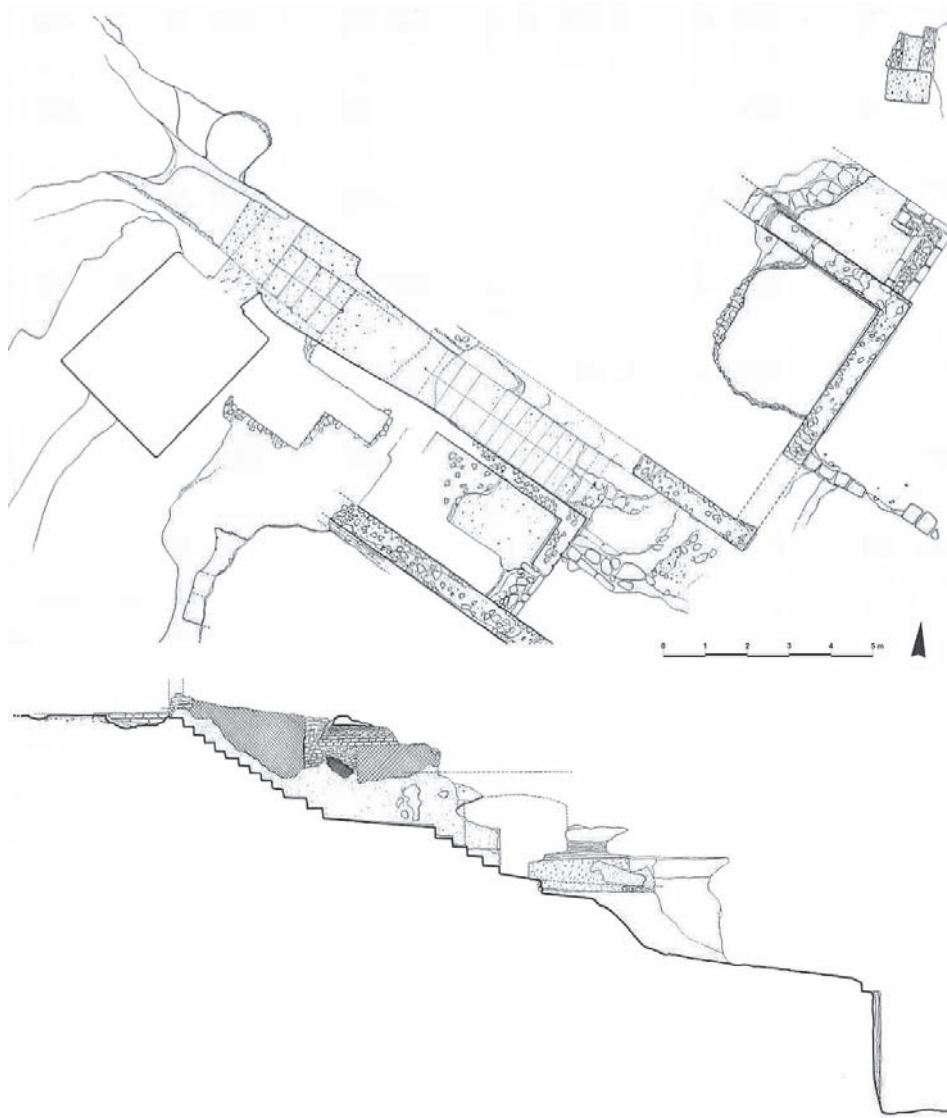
Punta Eolo, corridoio di discesa a mare A. 5, planimetria e sezione (De Rossi 1986: Fig. 220 e 221).
